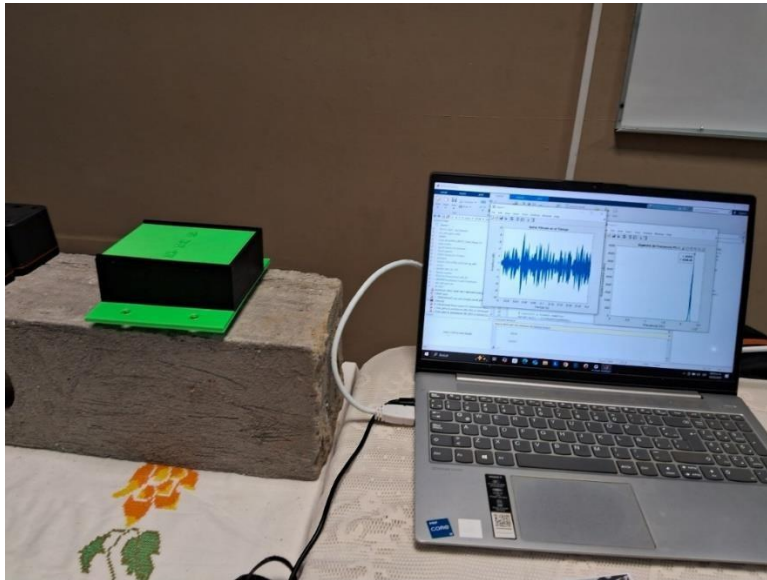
Análisis en las probetas de concreto reforzado. Fuente: El autor.
